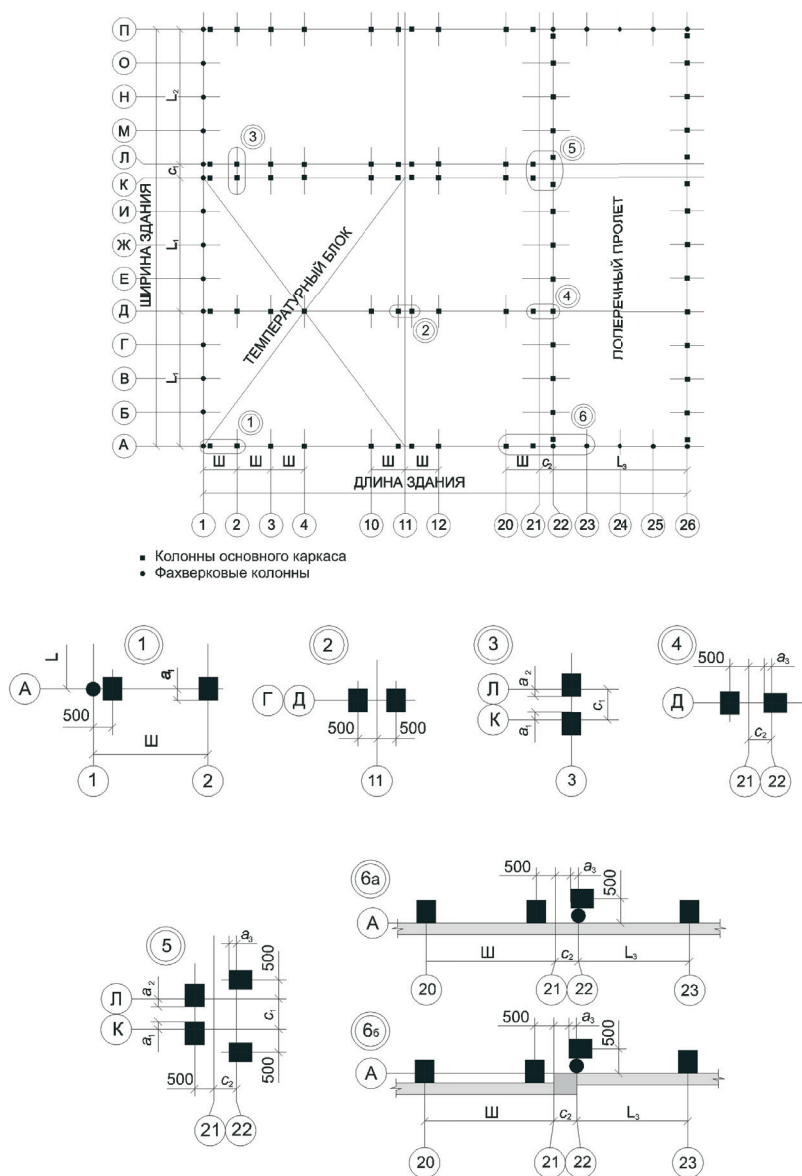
Схематический план (сетка разбивочных осей) одноэтажного здания с тремя продольными и одним поперечным пролетами и узлы к нему
